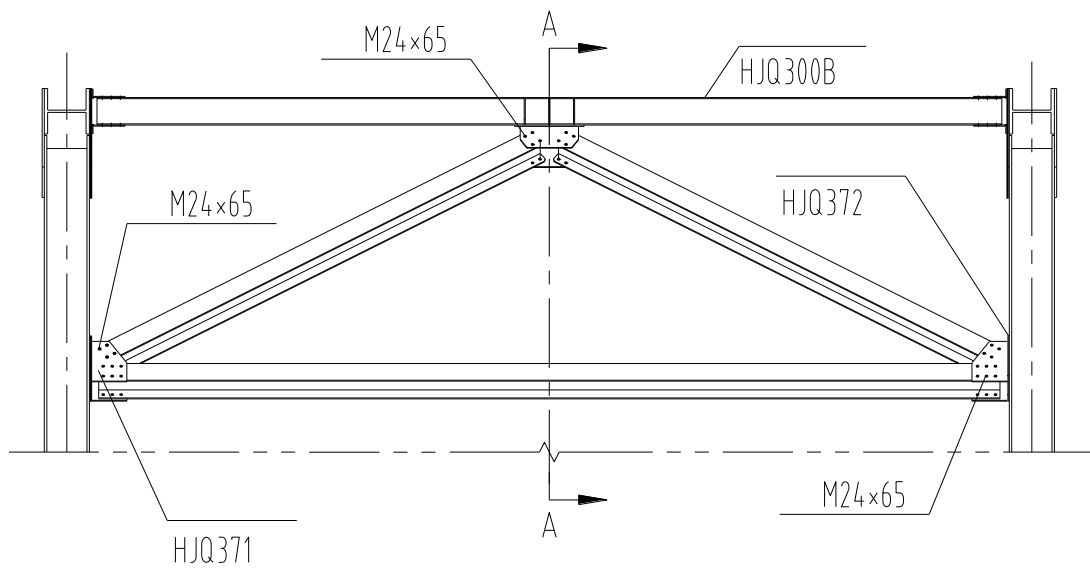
Detalle para la conexión de la entrada de 81.9m y 100.1m a
